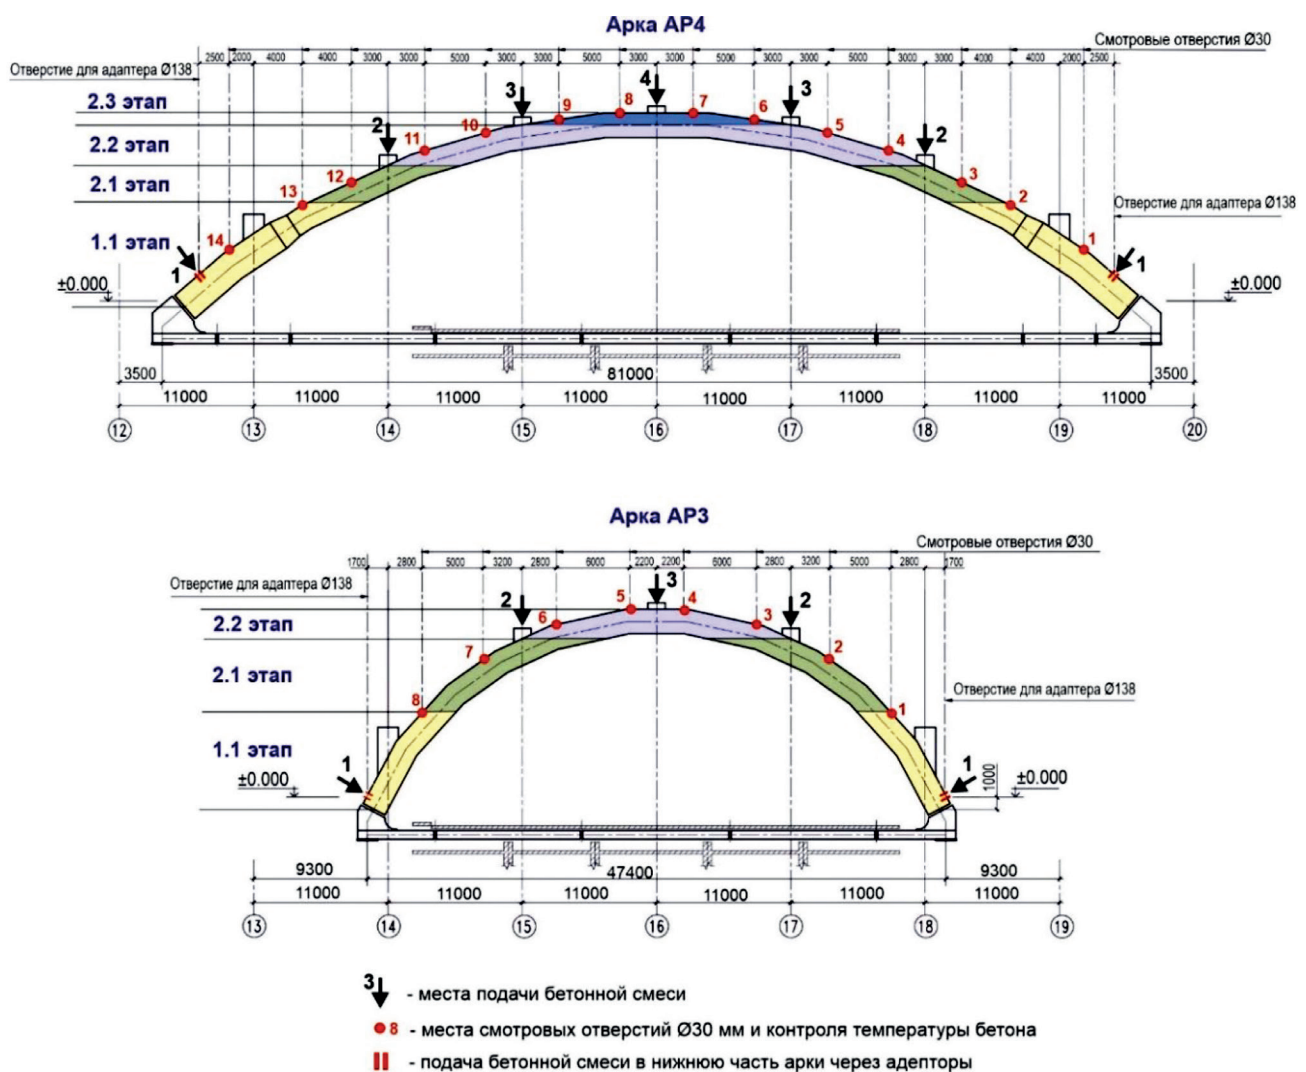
Схема укладки бетонной смеси по сечению конструкции арок
